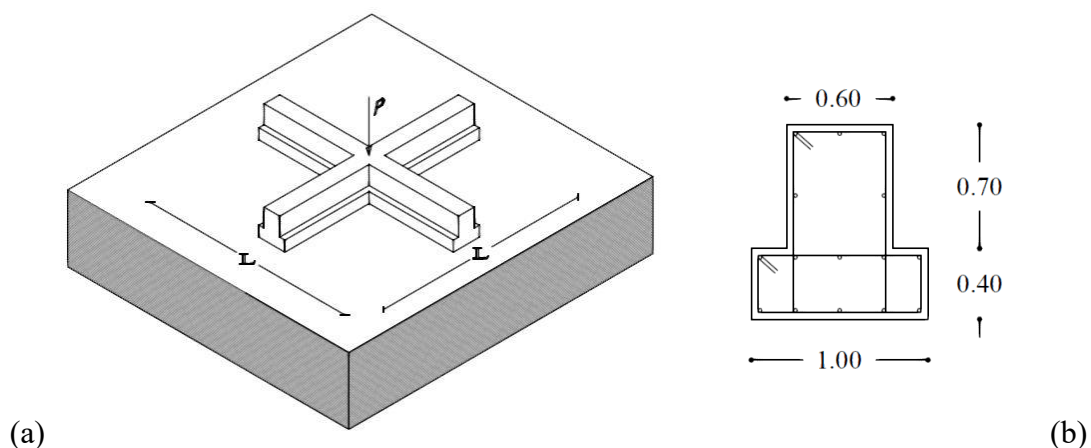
Travi di fondazione incrociate soggette a carico verticale. Vista tridimensionale (a); dimensioni (in metri) sezione trasversale delle travi (b).
